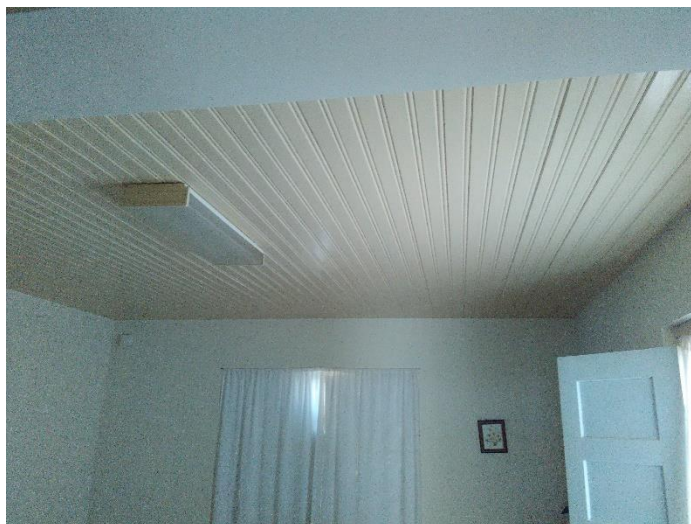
7 - Pavimento em madeira com revestimento inferior em madeira
